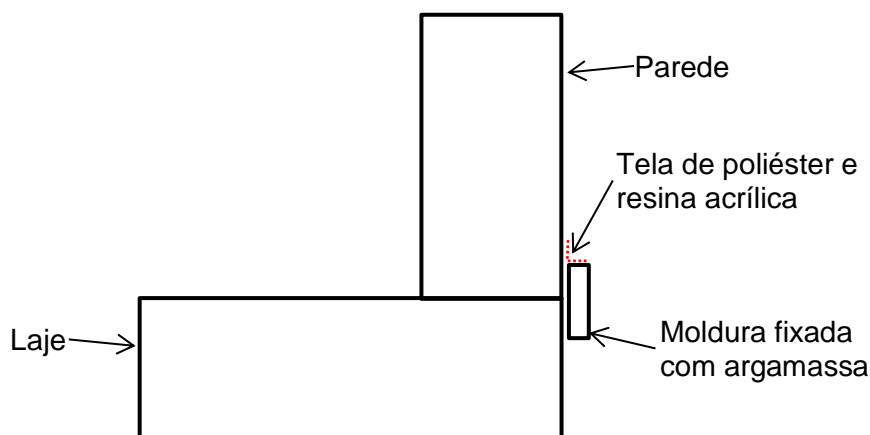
Juntas horizontais entre paredes e laje (sem escala)
